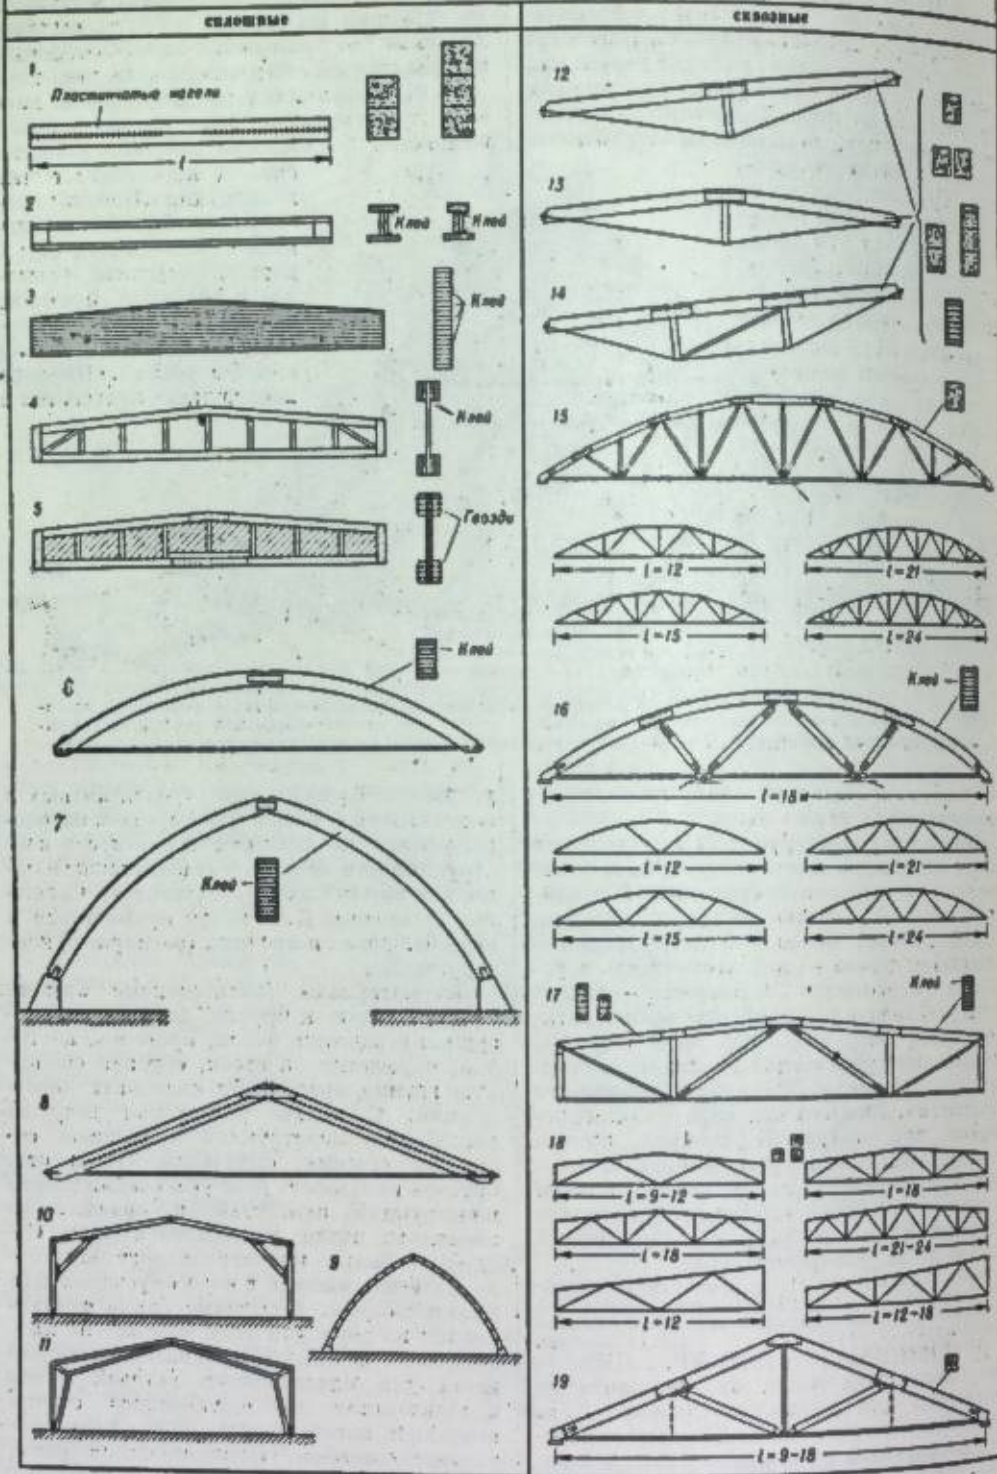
Основные формы деревянных конструкций: 1 — составные брусовые балки на пластинчатых нагелях, $l=6-9$ м; 2 — клееные балки со стенкой из досок на ребро для междуэтажных и чердачных перекрытий, $l=3-7$ м; 3 — двускатные клееные балки на досках плашмя, $l=6-15$ м; 4 — клееные балки с фанерной стенкой; 5 — гвоздевые клееные балки с перекрестной дощатой стенкой, $l=6-12$ м; 6 — клееная арка на досках плашмя, $l=12-60$ м; 7 — то же; 8 — трехшарнирная арка из составных балок на пластинчатых нагелях, $l=7-12$ м; 9 — то же из косняков, $l=7-15$ м; 10 — трехшарнирная рама из брусьев, $l=6-10$ м; 11 — трехшарнирная клееная рама с фанерной стенкой, $l=10-20$ м; 12, 13 и 14 — шпренгельные балки и фермы, $l=6-15$ м; 15 — многоугольные брусовые фермы системы ЦНИИСК, $l=12-36$ м; 16 — клееные сегментные фермы ЦНИИСК, $l=12-36$ м; 17 — трапециевидные двускатные и односкатные фермы с клееным или из балок на пластинчатых нагелях верхним поясом, $l=12-24$ м; 18 — то же с верхним поясом из брусьев; 19 — треугольные фермы с верхним поясом из брусьев или из балок на пластинчатых нагелях или с клееным верхним поясом.
